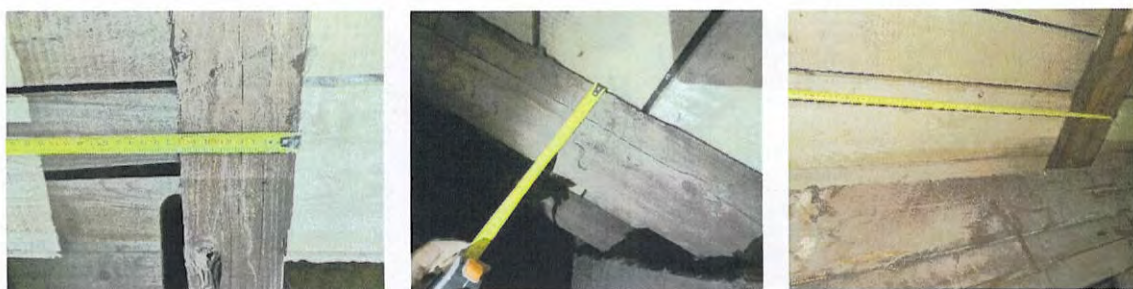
a, b– Aspect sondaje elemente șarpantă – căprior
